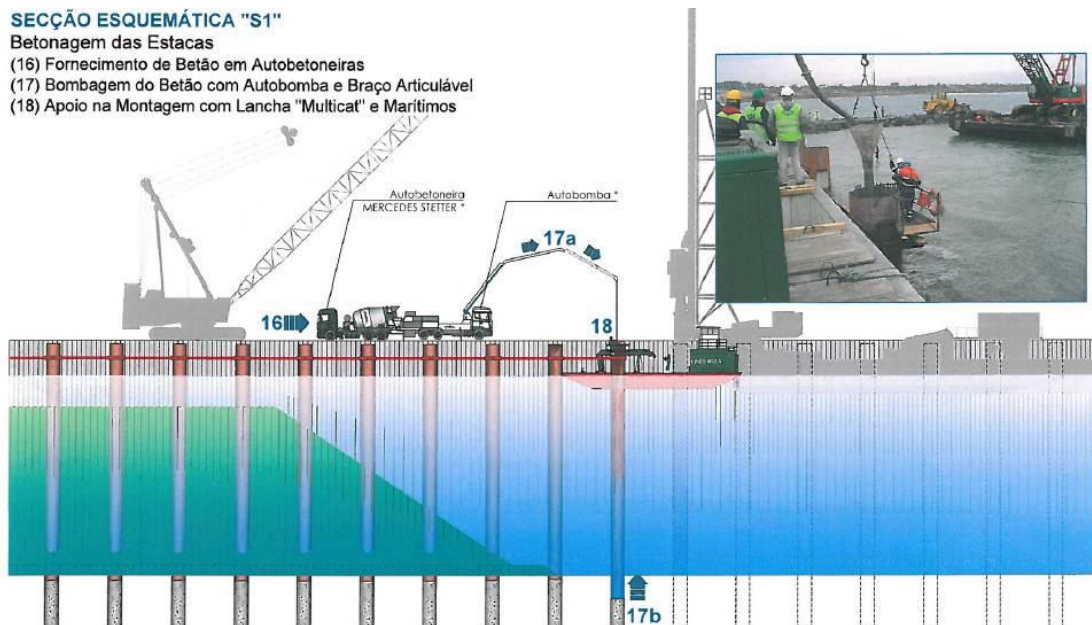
Desenho Esquemático: Betonagem Armaduras [30]
